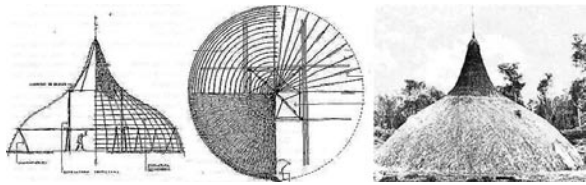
Planta, alzado y vista general del cobijo "Churuata" de la etnia Piaroa, Venezuela
